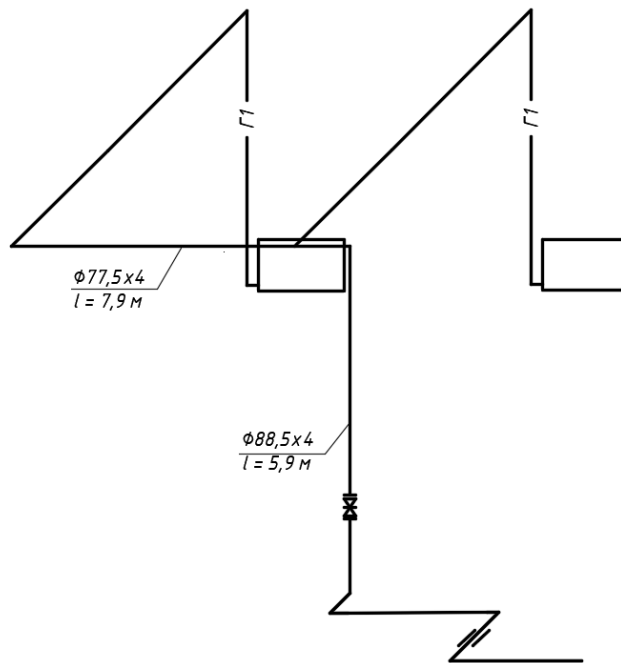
Расчетная схема внутрикотельного газопровода
